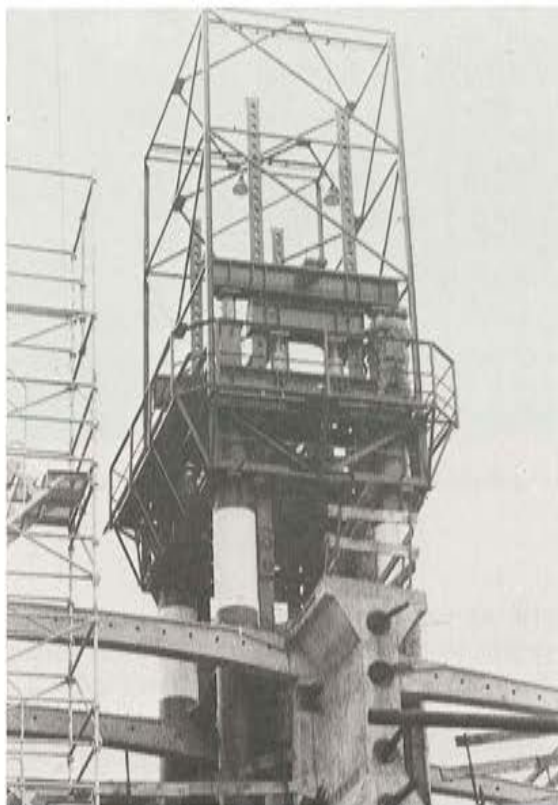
Detalle de la torre de elevación. (Foto Aéroport de París).
